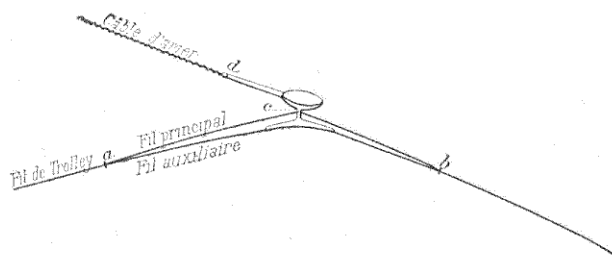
Schéma de l'installation du fil auxiliaire.
